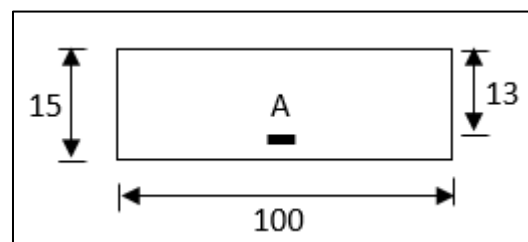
Section du calcul d'une dalle pleine en travée sens x-x
